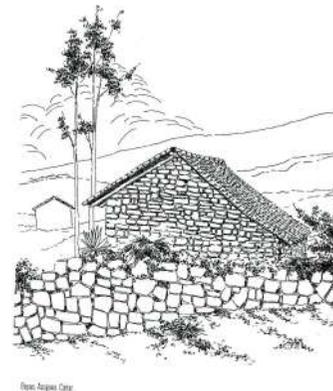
Uso de la piedra en muros portantes de vivienda y en muro de cerramiento.
